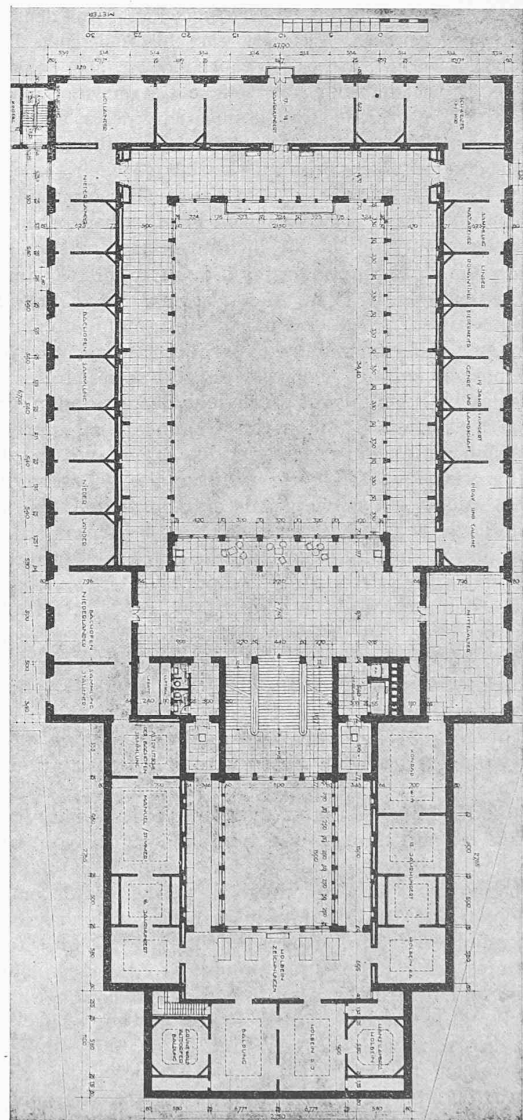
Grundriss vom I. Stock. — 1 : 700.
